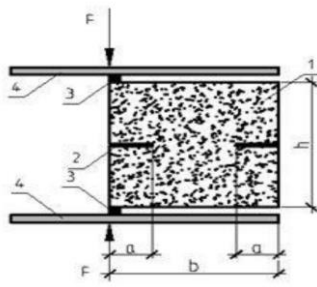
Схема нагружения образца для расчета K_{IC} : 1 – изделие; 2 – надрезы; 3 – металлические пластины; 4 – плиты пресса; h – высота образца, м; b – ширина образца, м; a – глубина надреза, м, $a = h / 4$; F – нагрузка, действующая на образец в процессе испытания, Н
